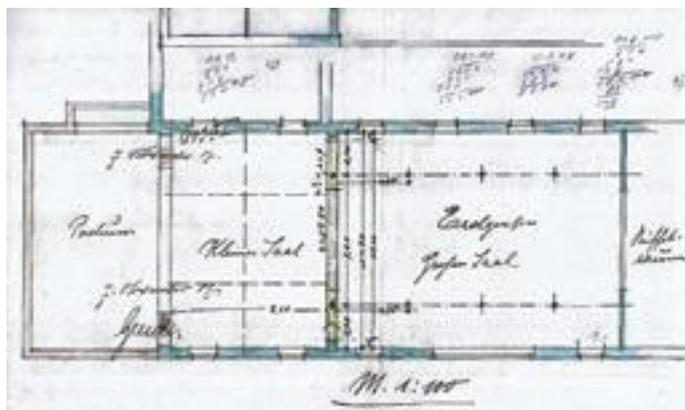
Erdgeschossgrundriss von 1907 (Ausschnitt), Comessastraße 42
